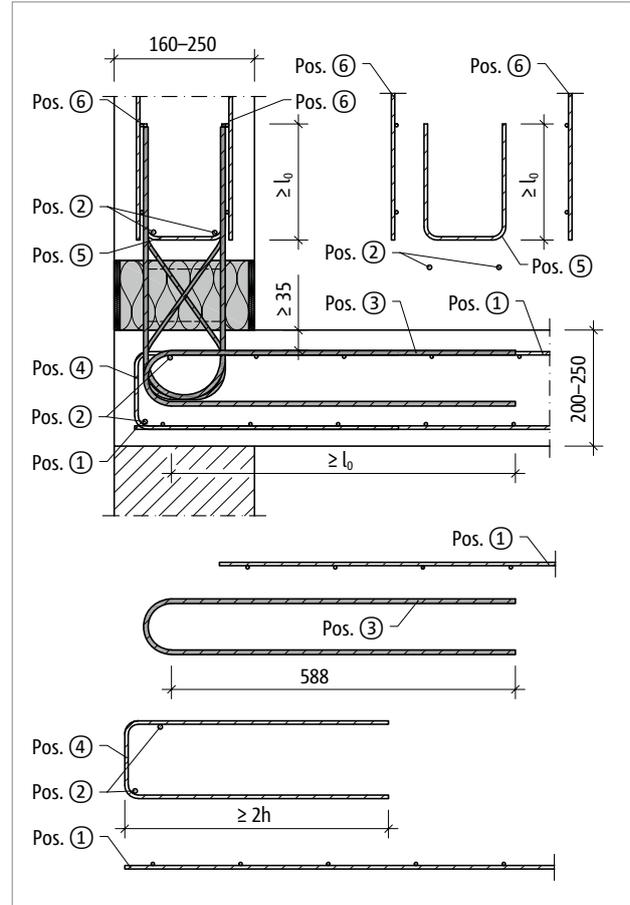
Schöck Isokorb® XT/T Typ A: Bauseitige Bewehrung außenliegend
